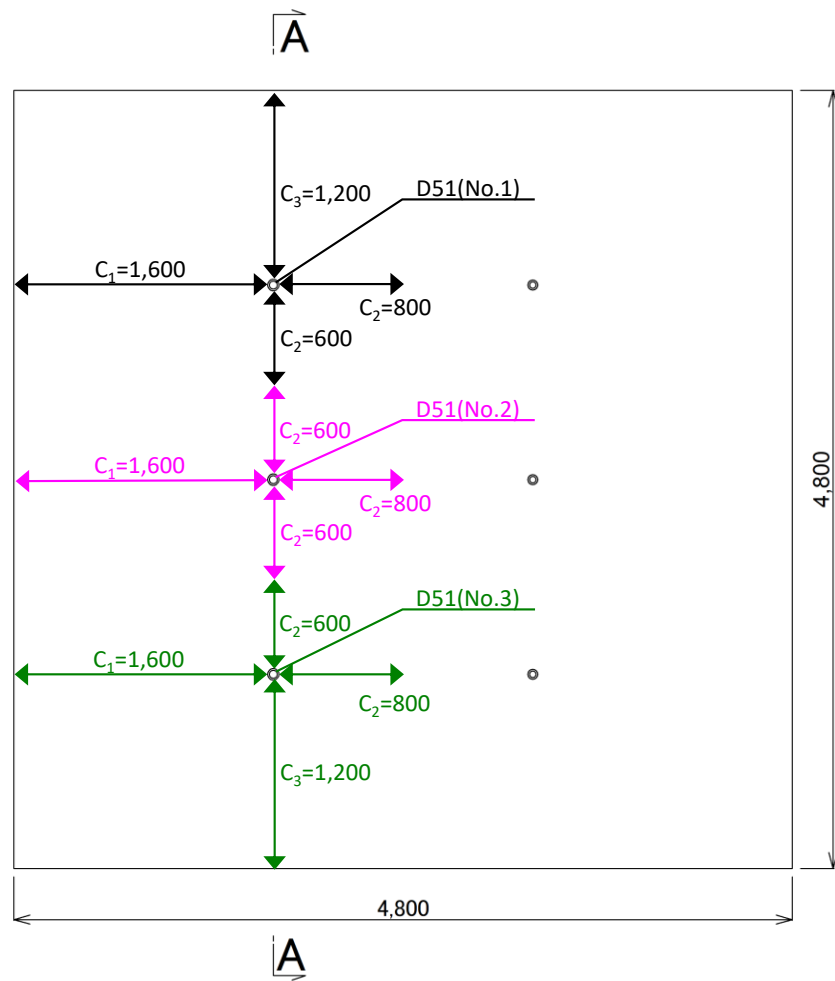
(1) 実験体の構造図* (供試体①の平面図)
